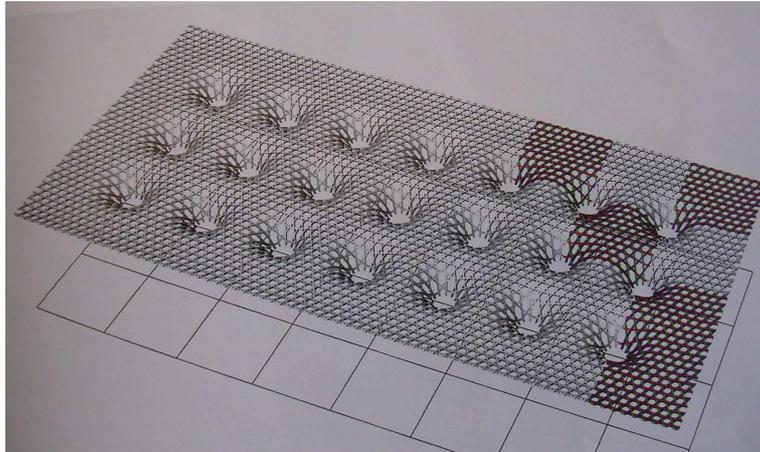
Dachkonstruktion mit den 21 Bäumen
